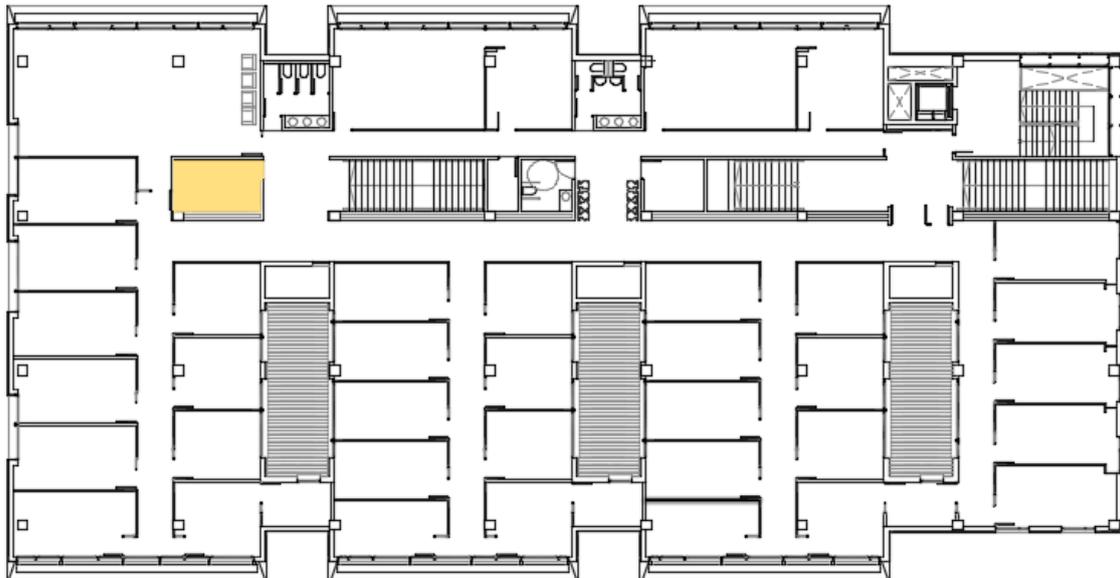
Situación RACK en Planta Primera. Figura extraída del plano 53.
